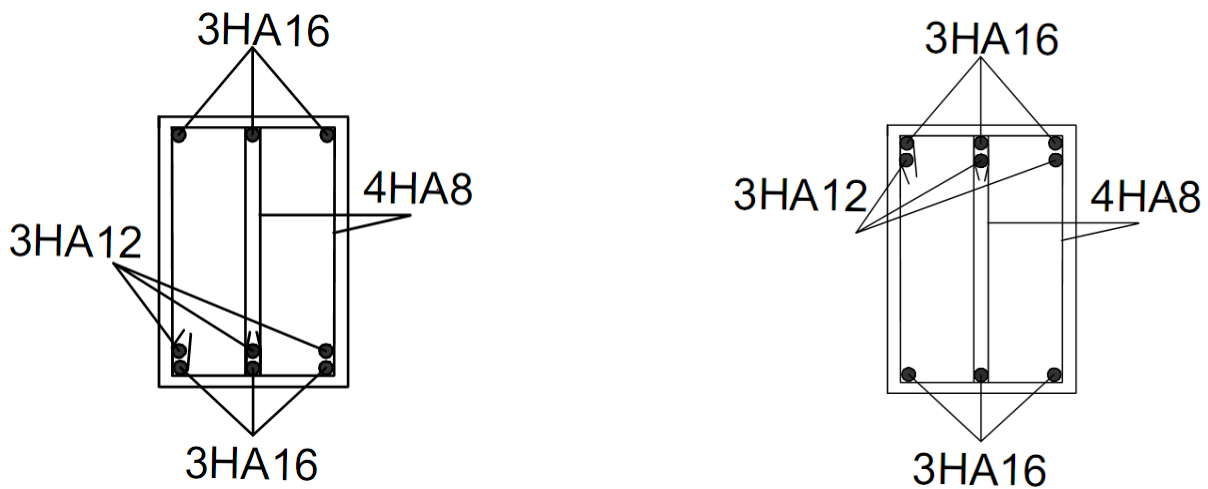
Schéma de ferrailage des poutres principales pour tous les étages.
